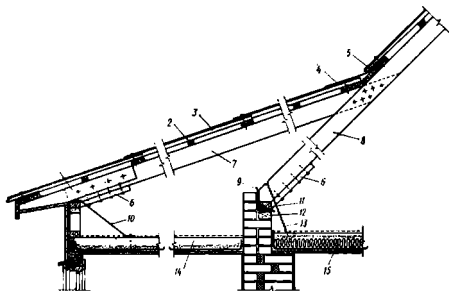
Крыша и чердачное перекрытие над верандой (сечение I—I на рис. X.1, в):
